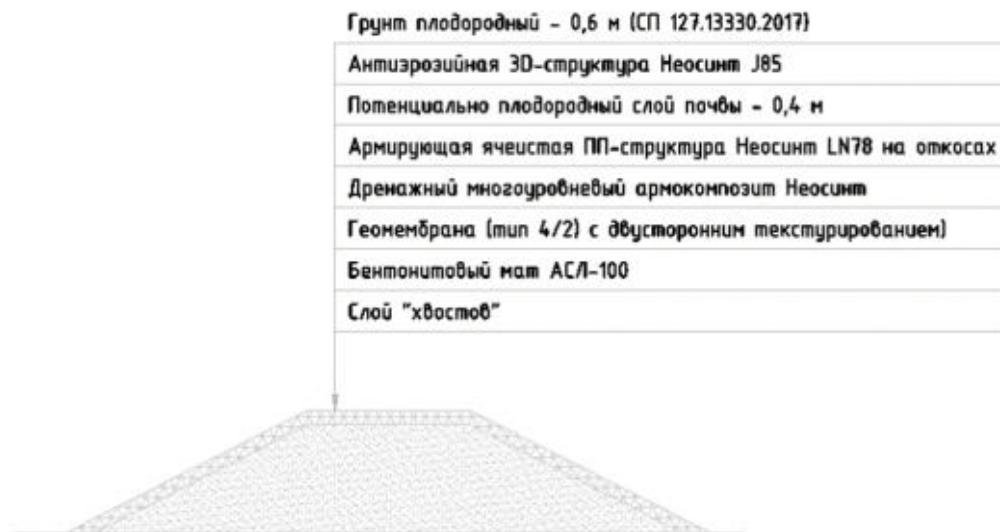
Схема слоёв финального перекрытия карты.
